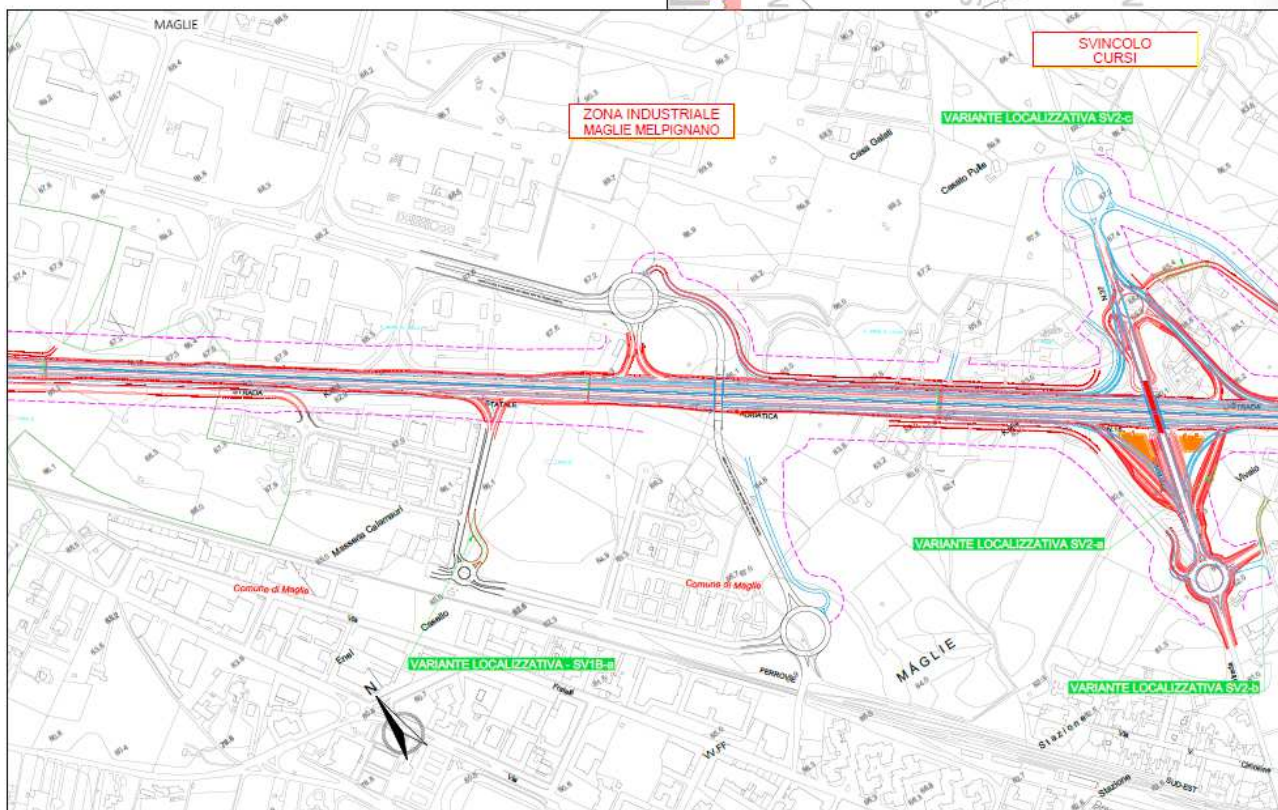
Planimetria delle varianti - SV1B Zona Industriale Maglie
